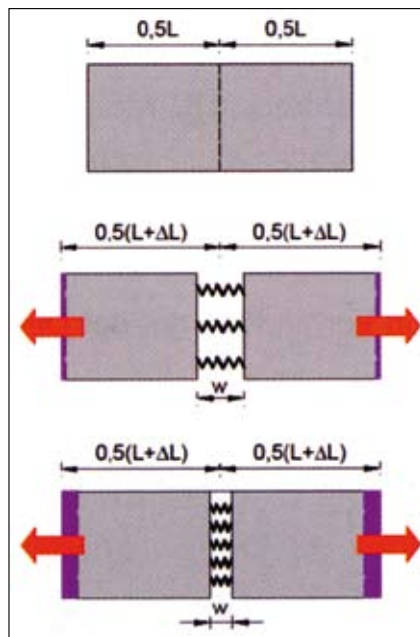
Модель расчета соединения сторон трещины при растяжении строительного элемента. Фиолетовые полосы показывают растяжение кладки при различном количестве спиральных анкеров.
